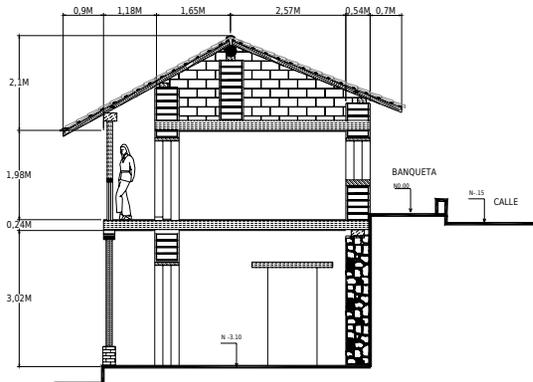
CORTE COSTRUCTIVO DE LA FICHA No. 3.
